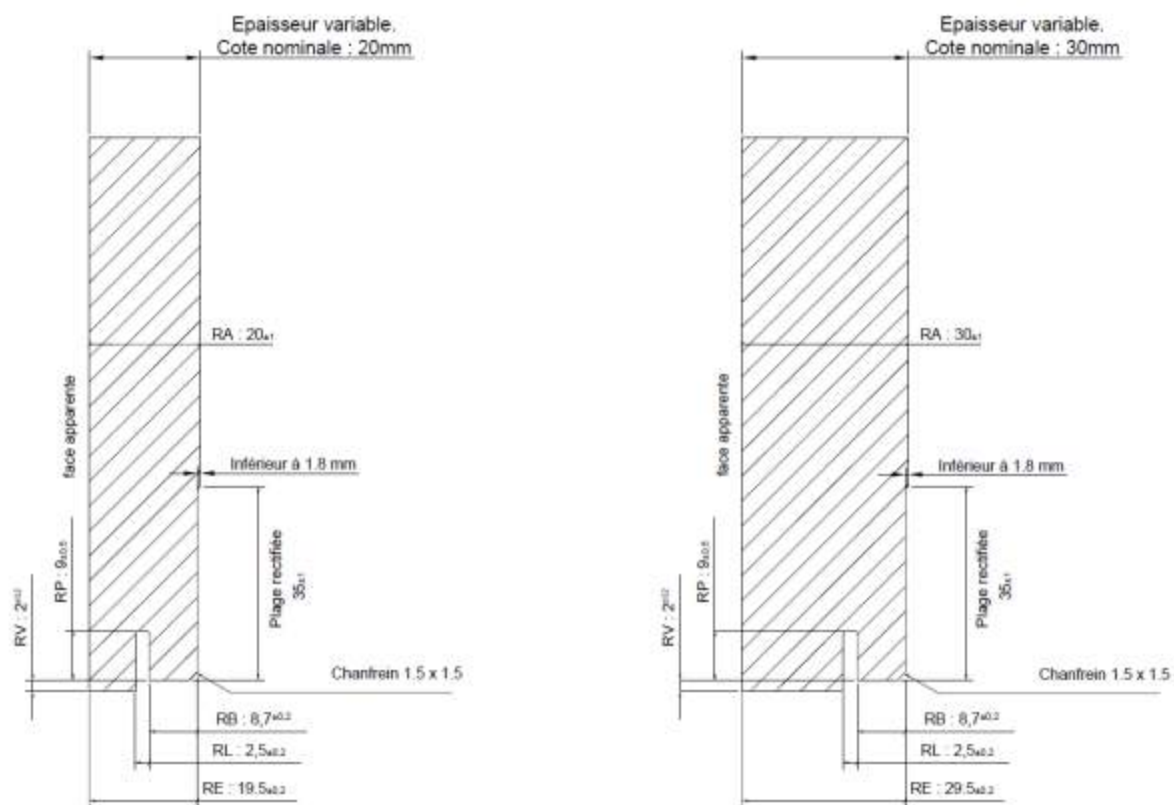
Rainurage Type B sur pierre de 2 et 3 cm
